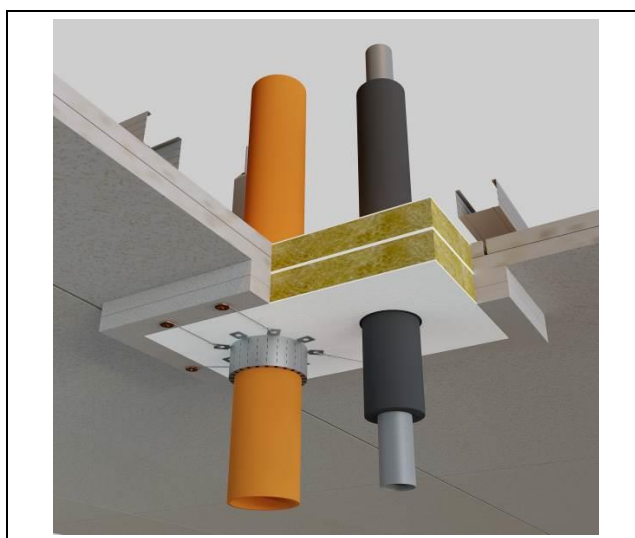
Exemple de joint AF PANEL dans un faux plafond EI 120.
